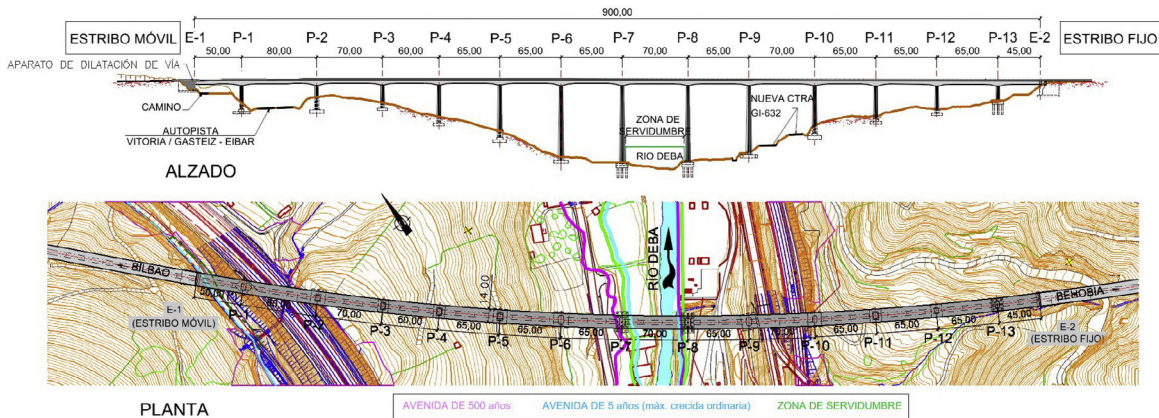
Alzado y planta de la solución finalmente construida de hormigón pretensado y canto variable.
